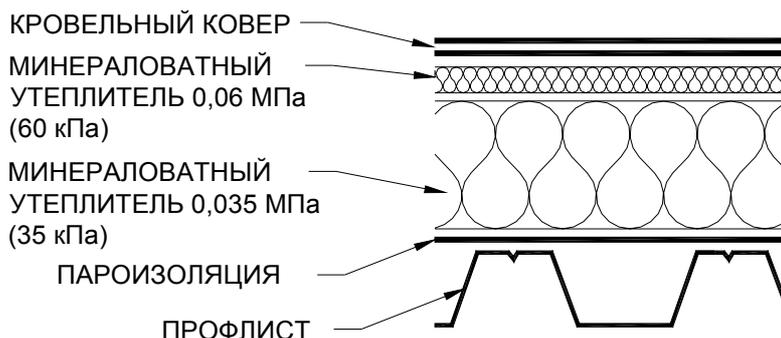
Конструкция покрытия с двухслойной теплоизоляцией из минераловатных плит.
